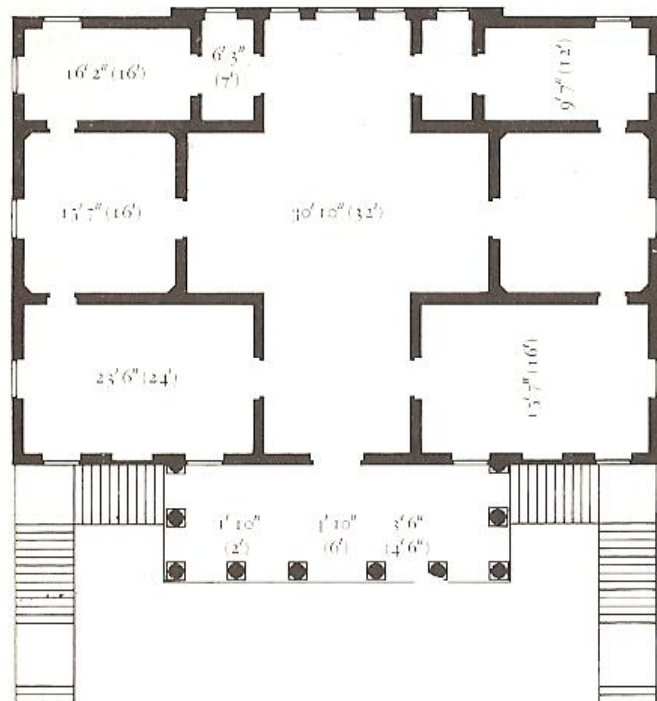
Andrea Palladio: Villa *Foscari*, Grundriss,
